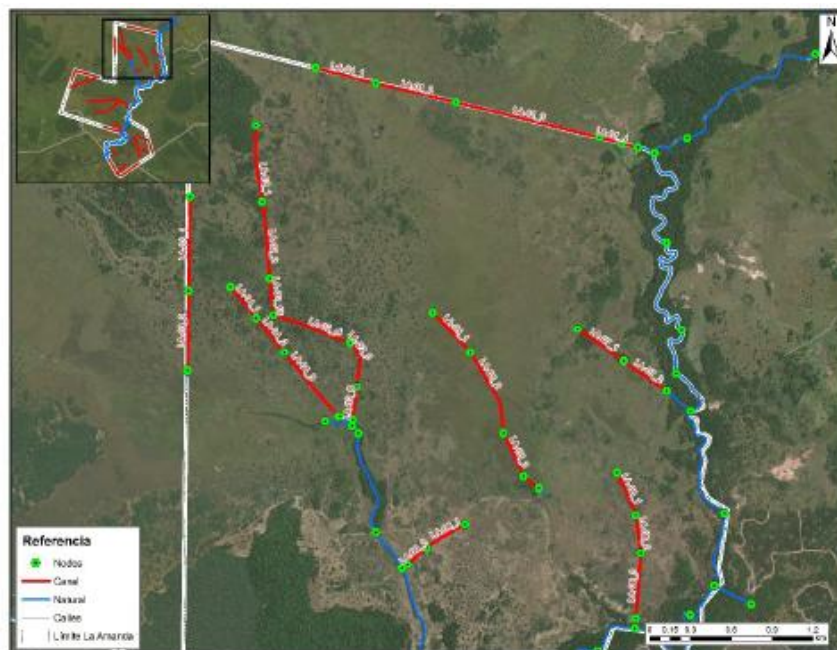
Esquema de trazado de canales propuestos. Sector Norte (1)
